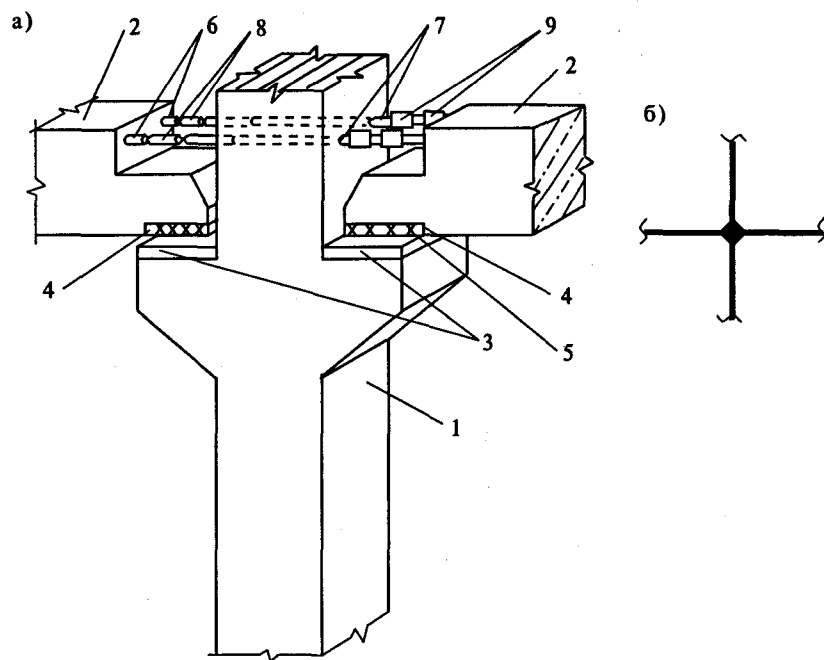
Жесткое соединение железобетонного ригеля с колонной:
